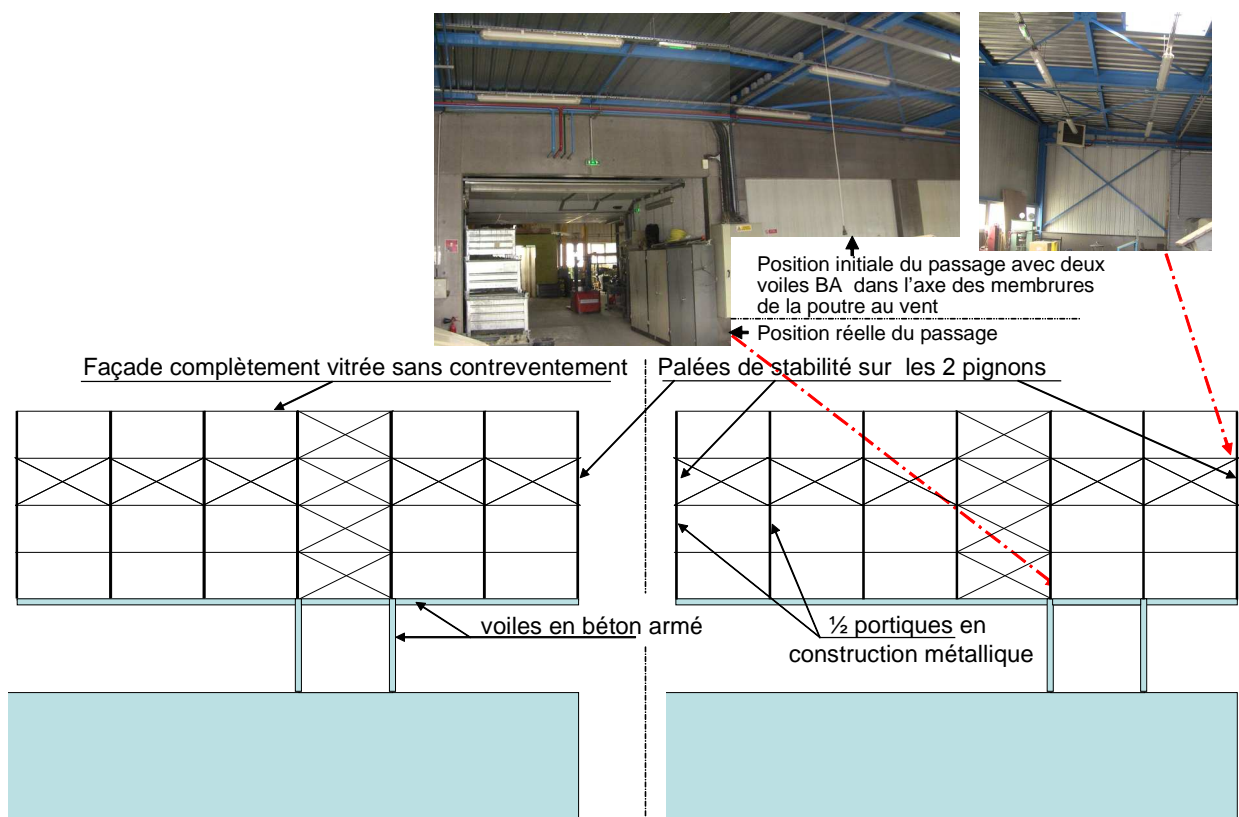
Exemple d'une circulation sans coordination entre les lots ou les intervenants du projet ; une des membrures de la « poutre au vent » parallèle aux pignons n'est plus articulée sur un point fixe et il s'ensuit une augmentation de la portée de la poutre longitudinale de contreventement horizontal.
